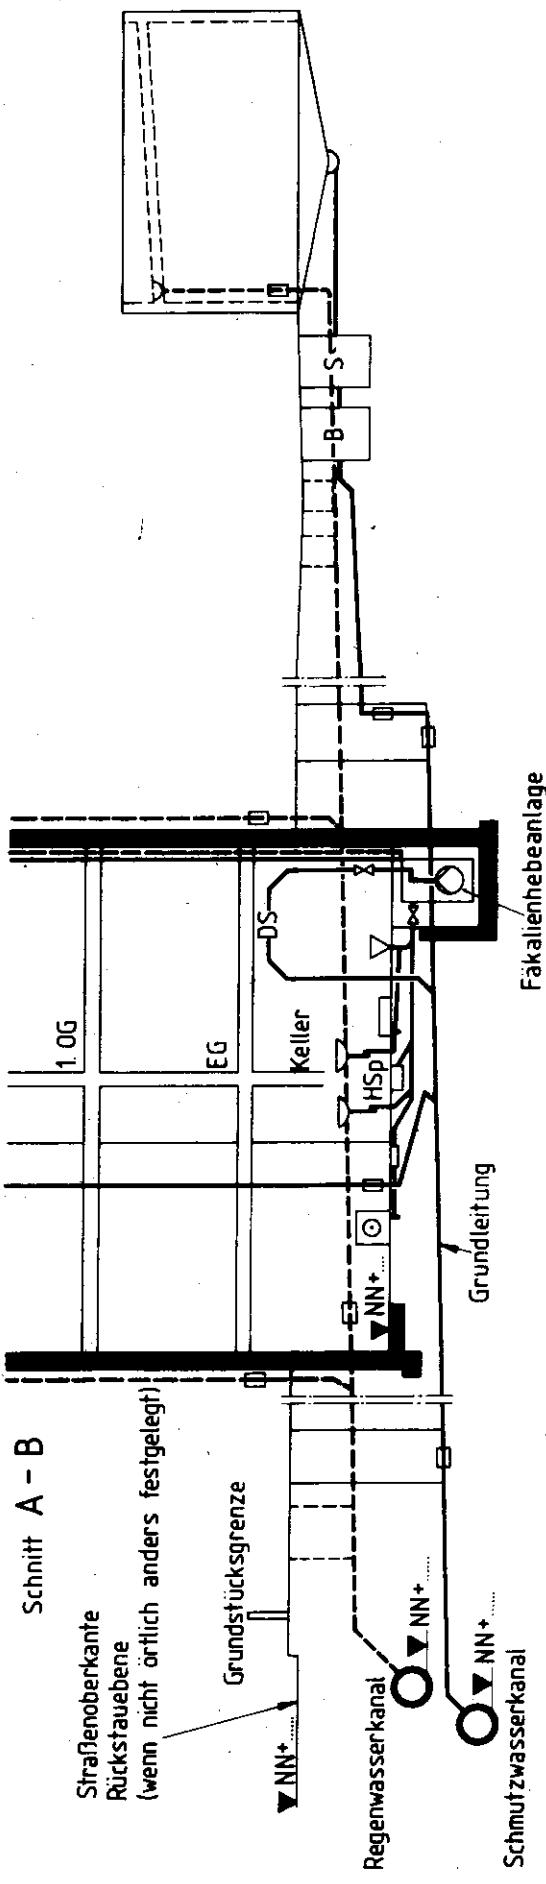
Leitungsschema zu Grundriß in Bild 2 (Schnitt A-B)
